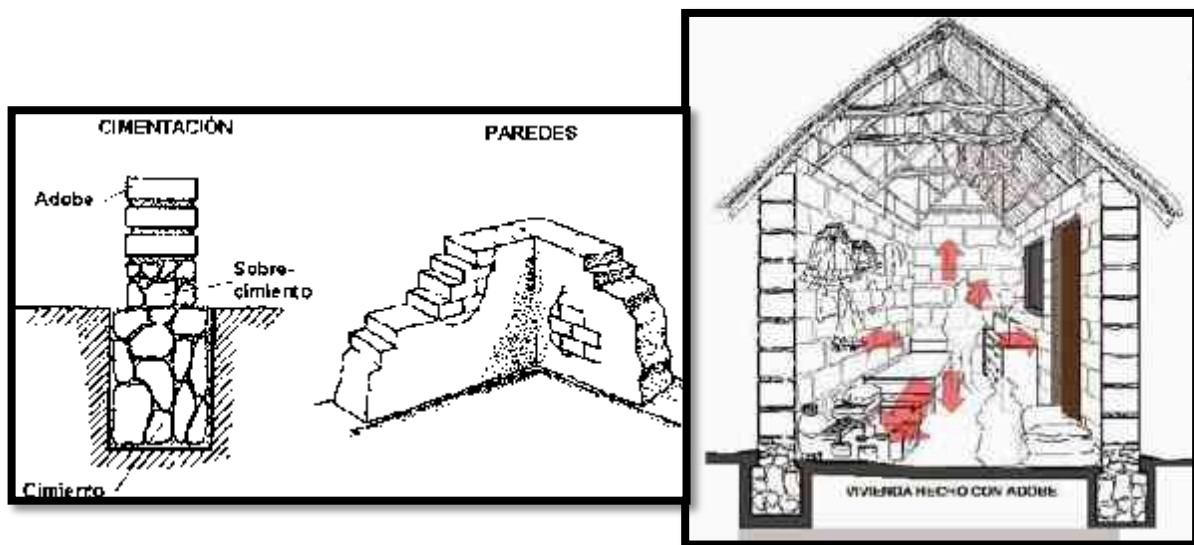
Ejemplo de un sistema constructivo con adobe.
